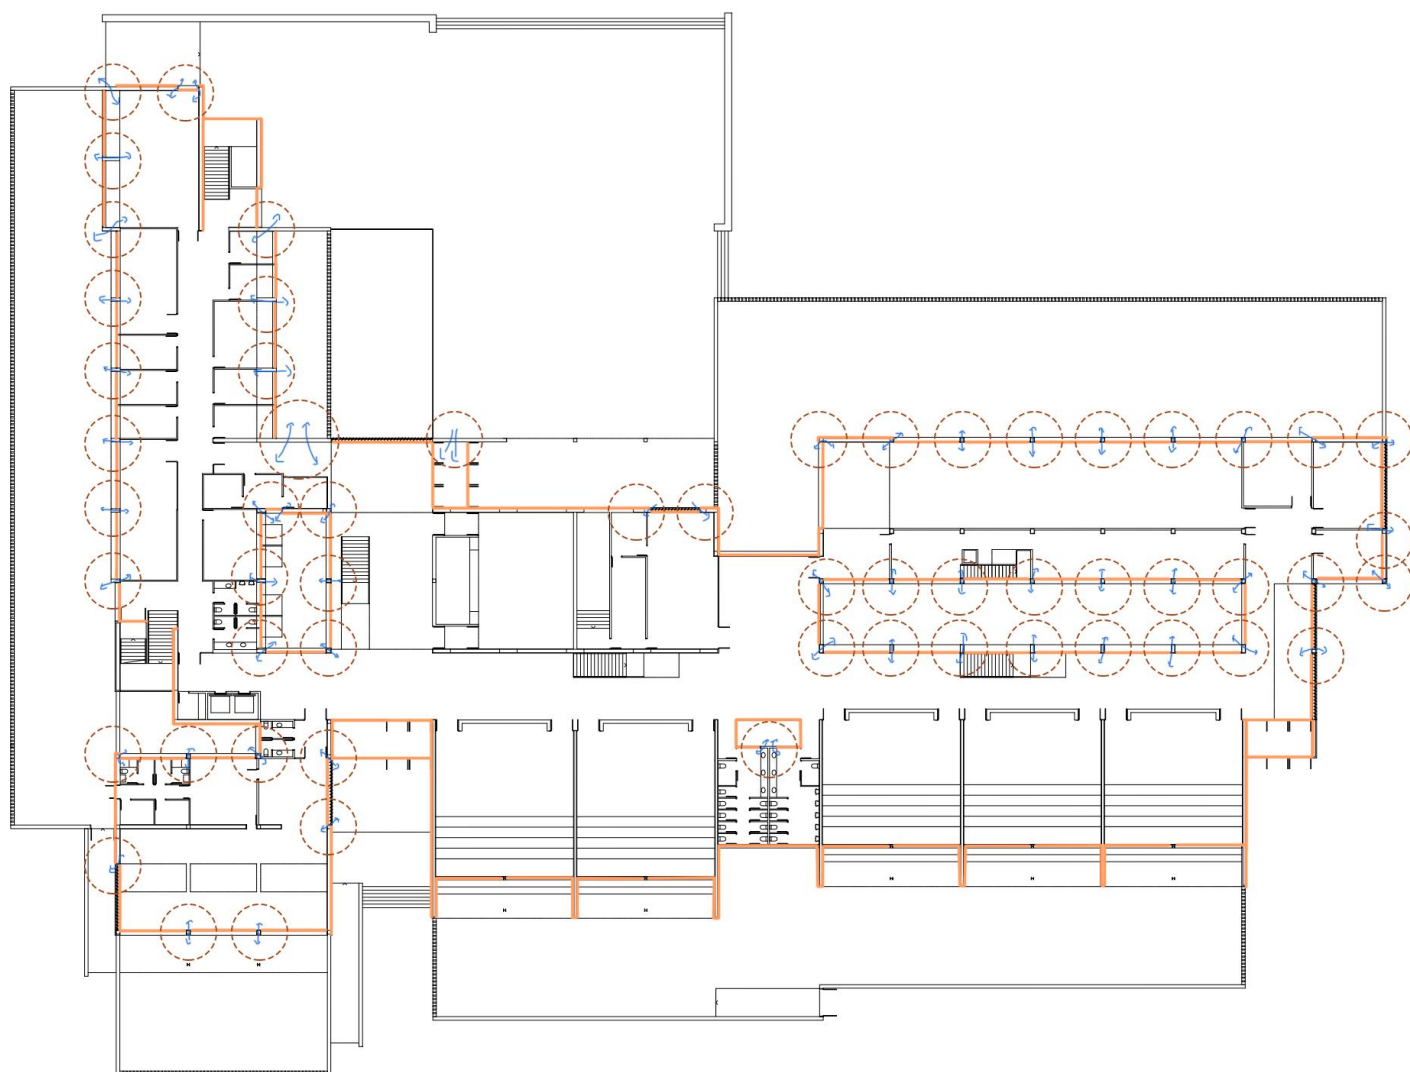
Identificación de puentes térmicos en planta baja. Fuente: Elaboración propia
